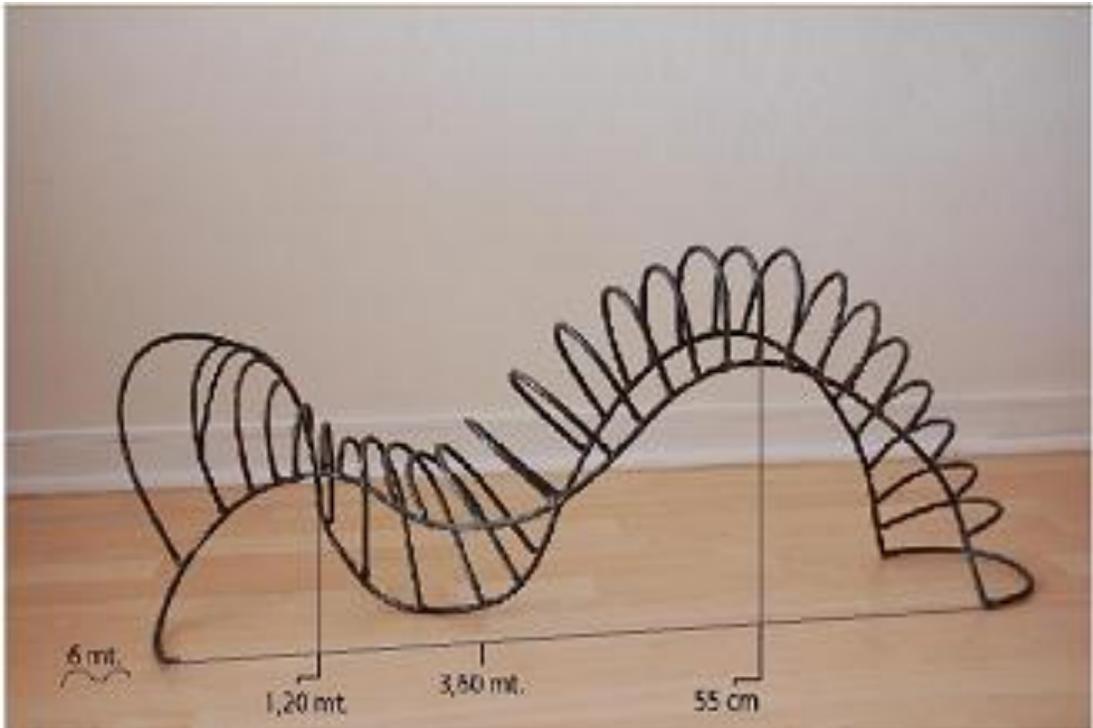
Maqueta a escala 1:5 - Estructura en fierro
